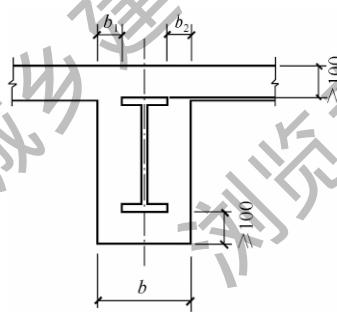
型钢混凝土梁中型钢的混凝土保护层最小厚度
